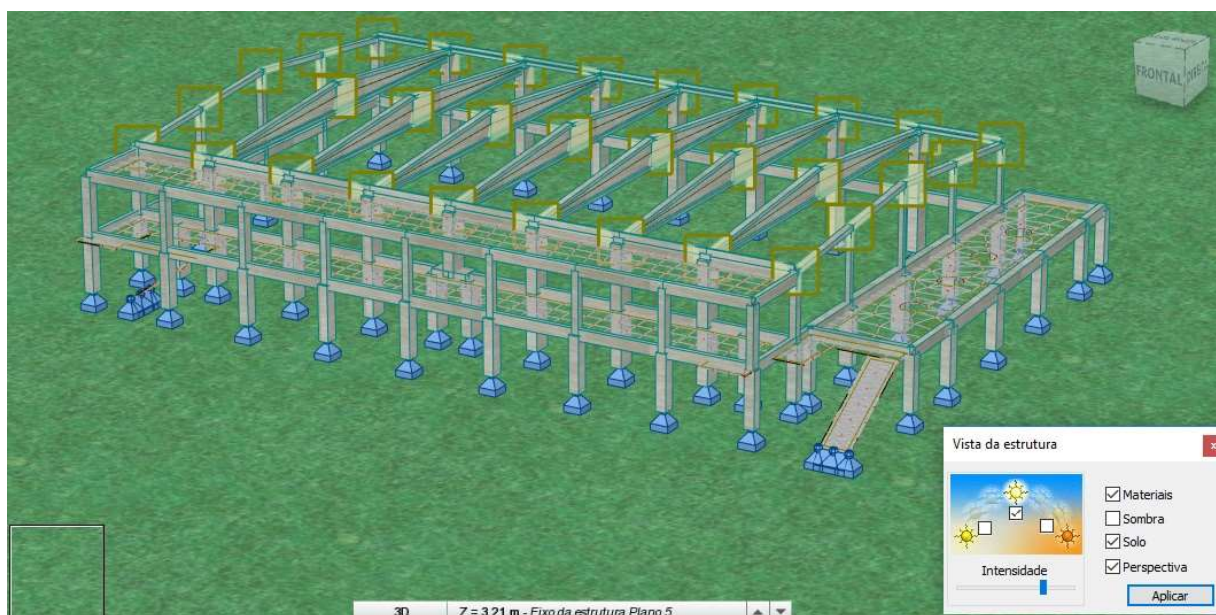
Perspetiva do gimnodesportivo (estrutura integral de betão armado com vigas delta)
